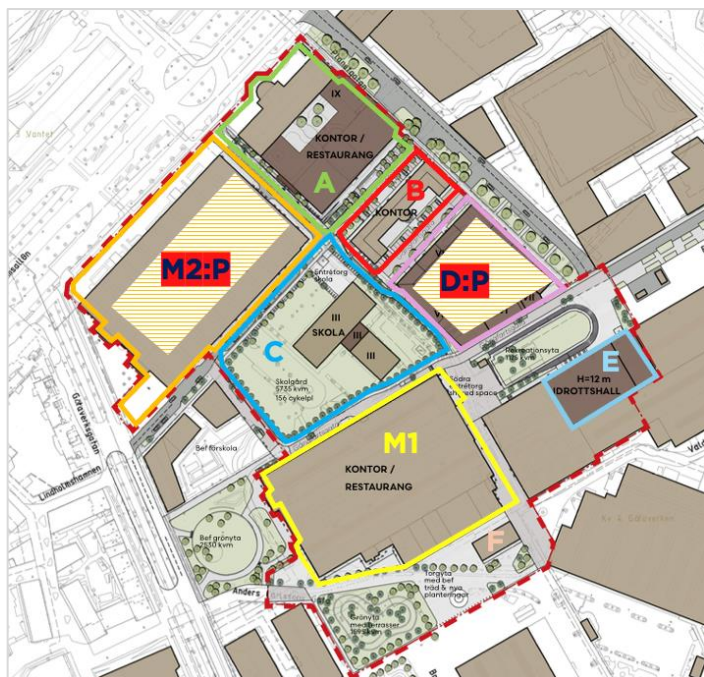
Översikt över parkeringsanläggningar för bil inom planområdet.
